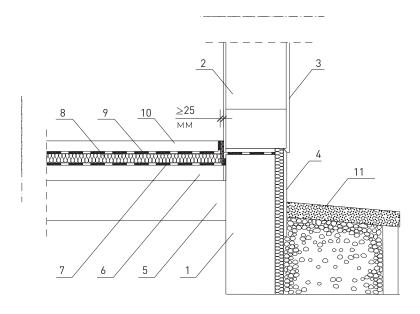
Фундаментная стена из монолитного тяжелого бетона с дополнительным утеплением
